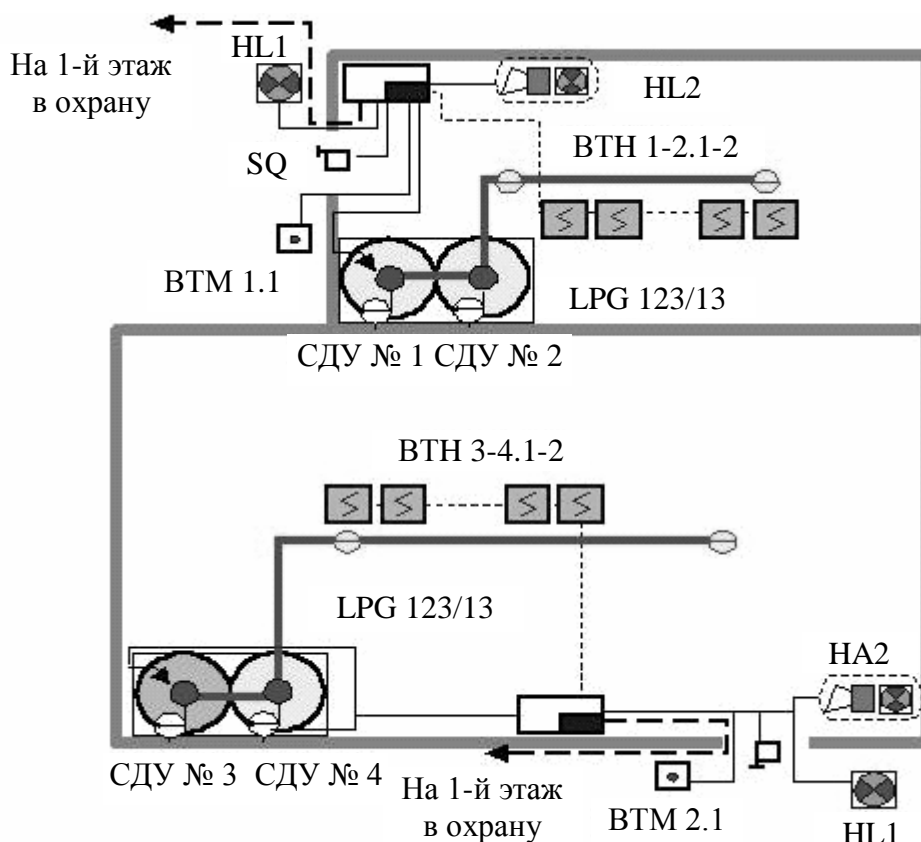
План защищаемых помещений с расстановкой оборудования УАГП
